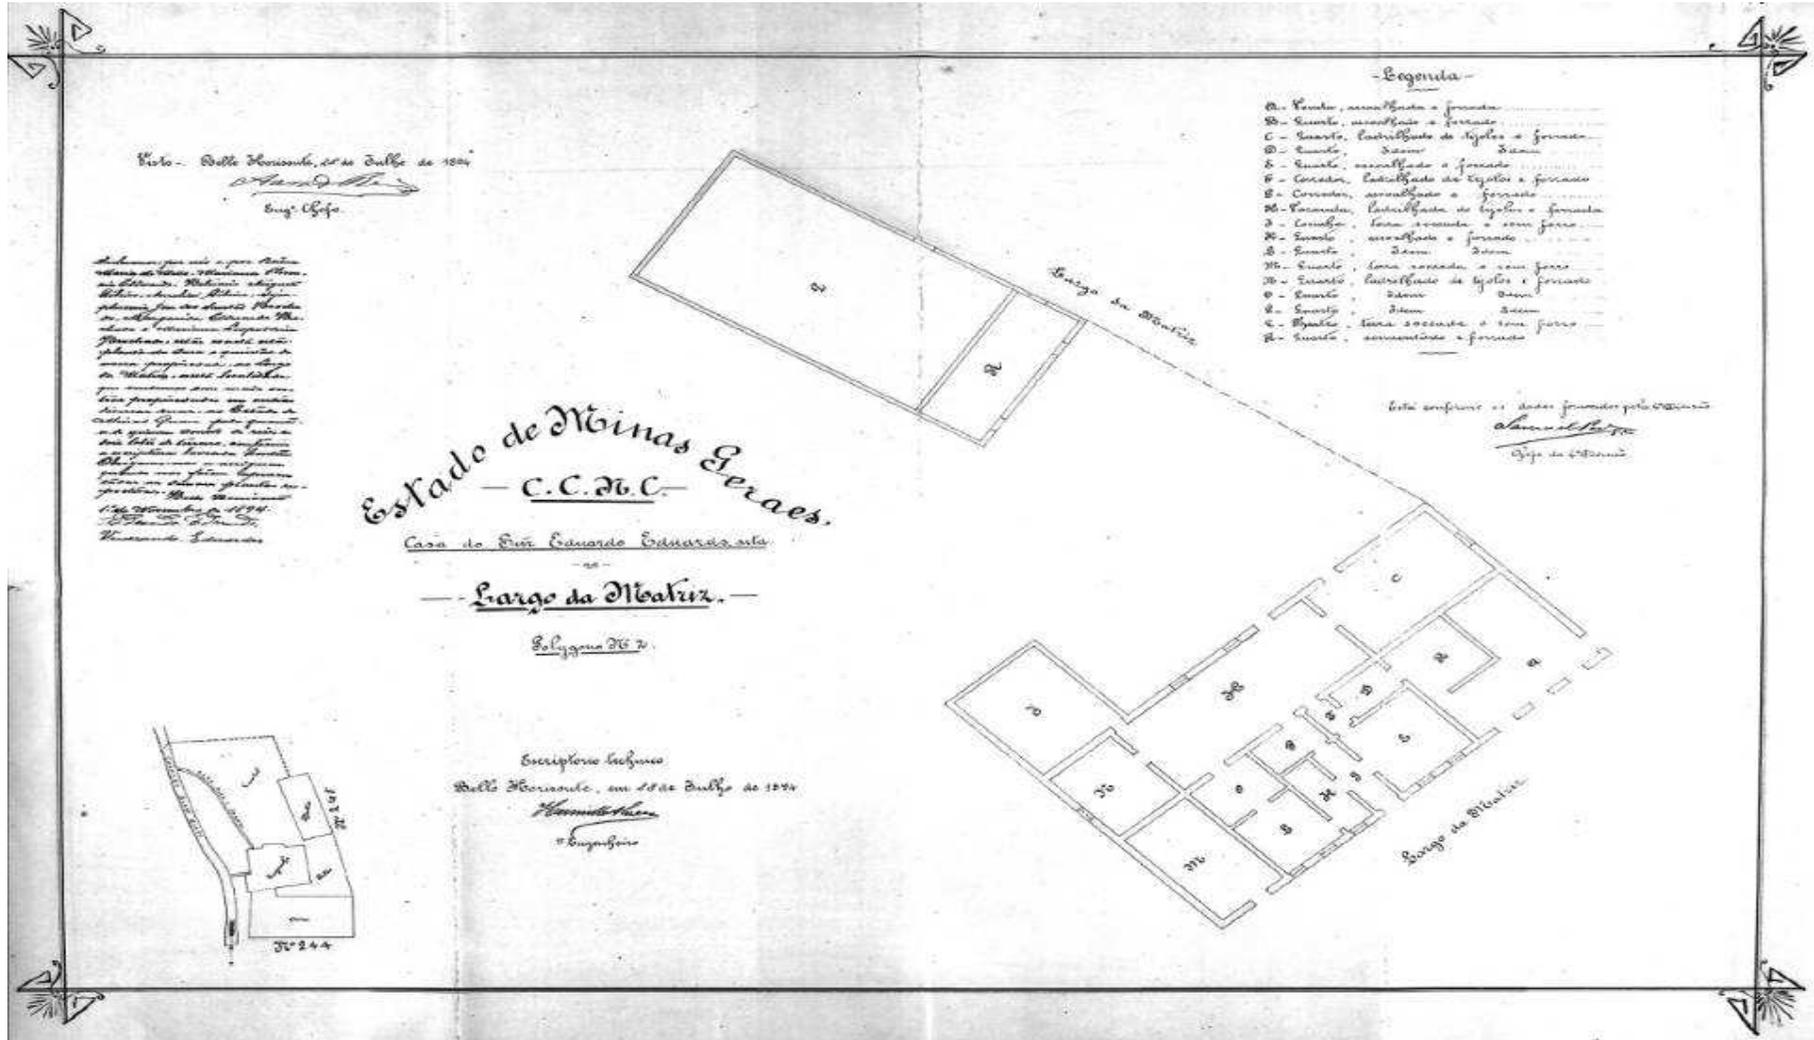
Planta da Casa de Eduardo Edwards, Largo da Matriz, Arraial de Belo Horizonte, 1894.
